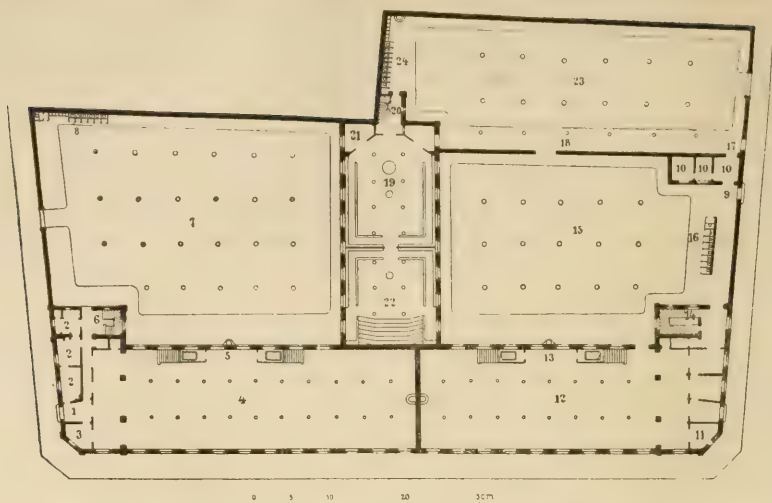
Grundriss einer französischen groupe scolaire. Aus Buisson⁴ und aus Narjoux⁵.
